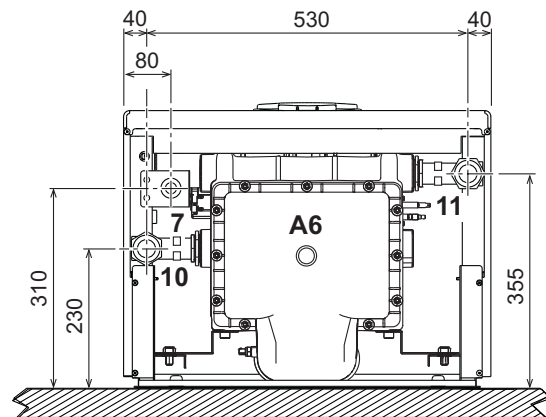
Vista dal basso mod. FORCE W 99 e FORCE W 120
